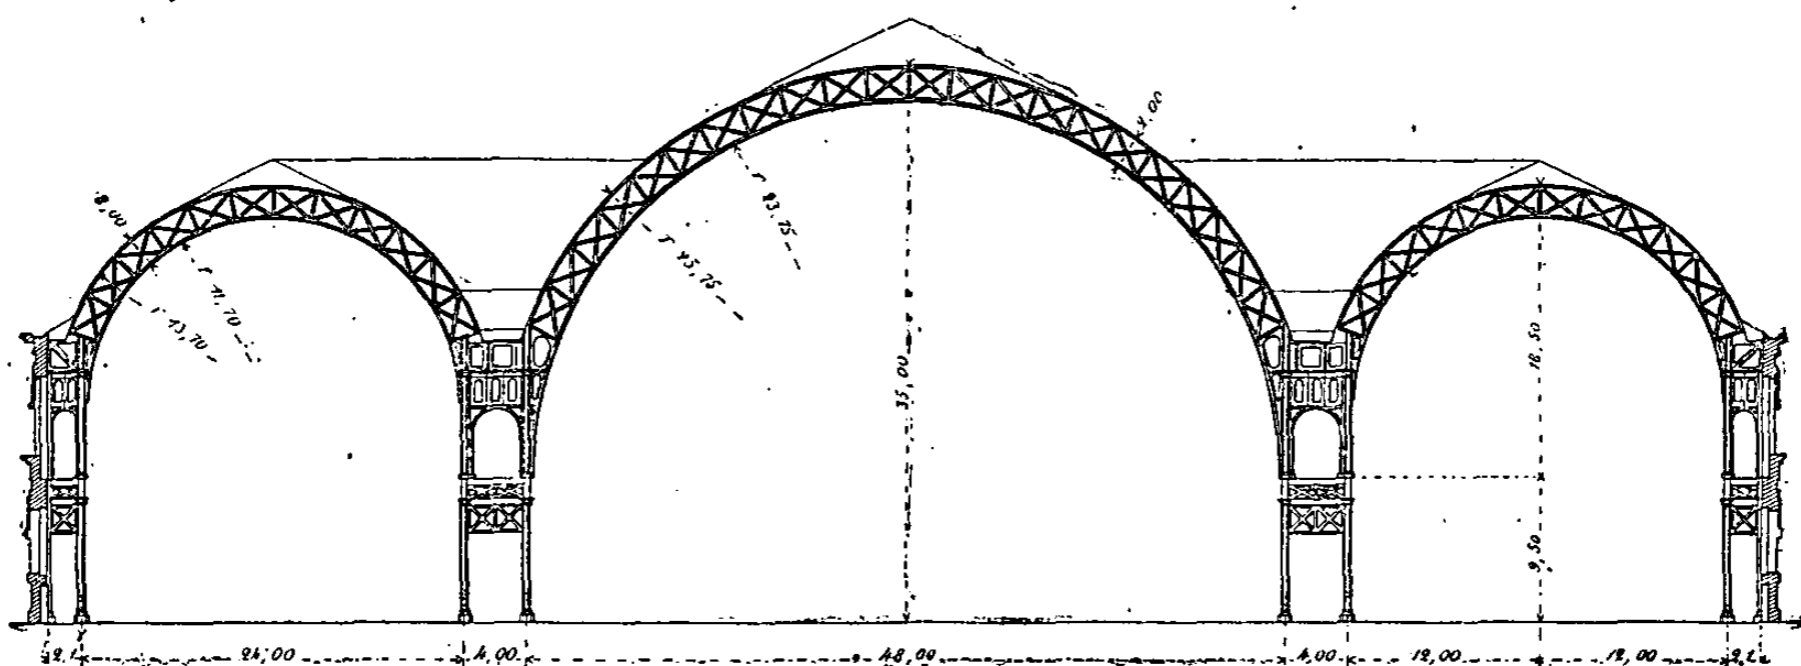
Coupe transversale du Palais de l'Industrie, construit pour l'Exposition universelle de 1855, à Paris.
